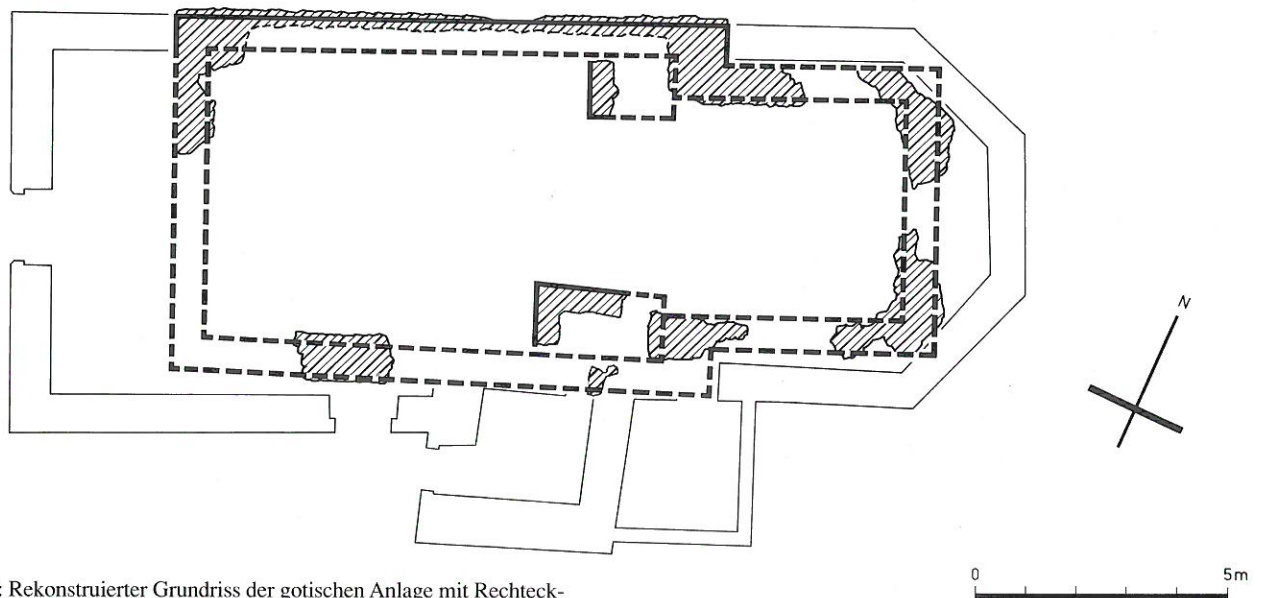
Rekonstruierter Grundriss der gotischen Anlage mit Rechteckchor. M. 1:150.
